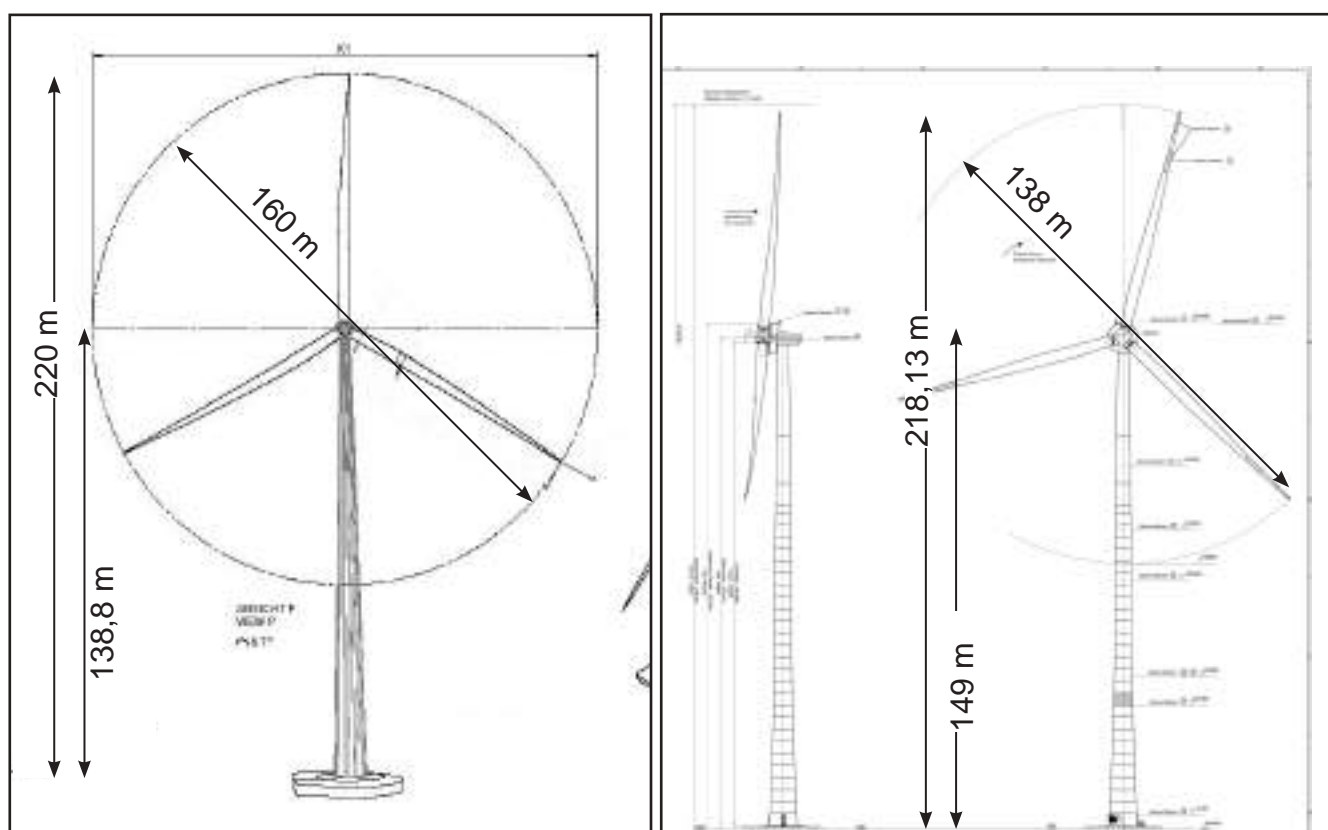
Dimensions de la E-160 EP5 E2, 220m bout de pale (gauche) et E-138 EP3 E2, 218,13 m bout de pale (droite)
